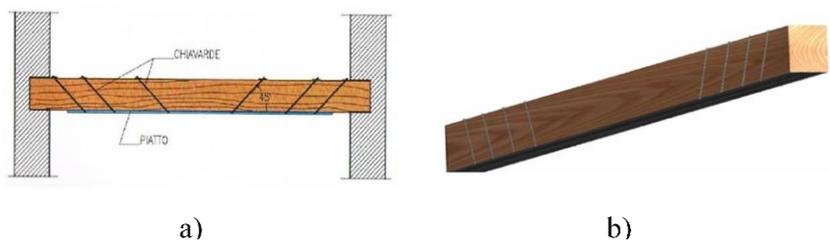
Reforço de viga através da colocação de chapa metálica na face inferior, conectada mecanicamente por parafusos a 45°: a) Proposta de (Mazzolani, 1991); b) Proposta de (França, 2007)
